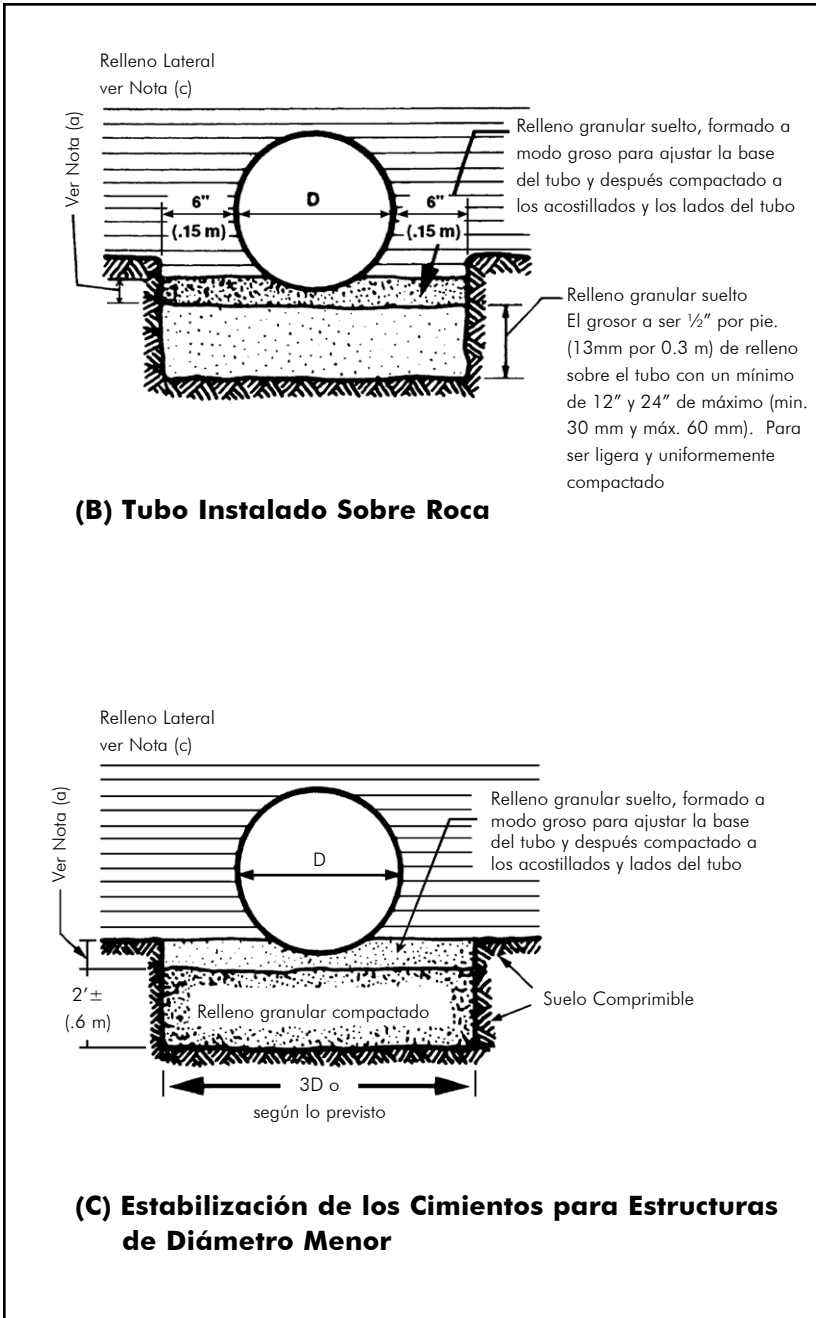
Detalles de la Cama de Apoyo y Relleno (continuación).
